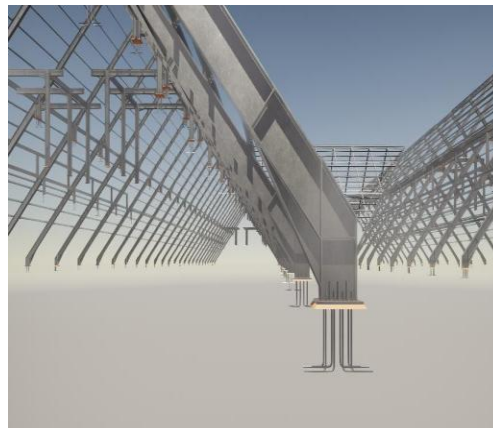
Detail Sambungan Kuda-Kuda Dengan Lasan
